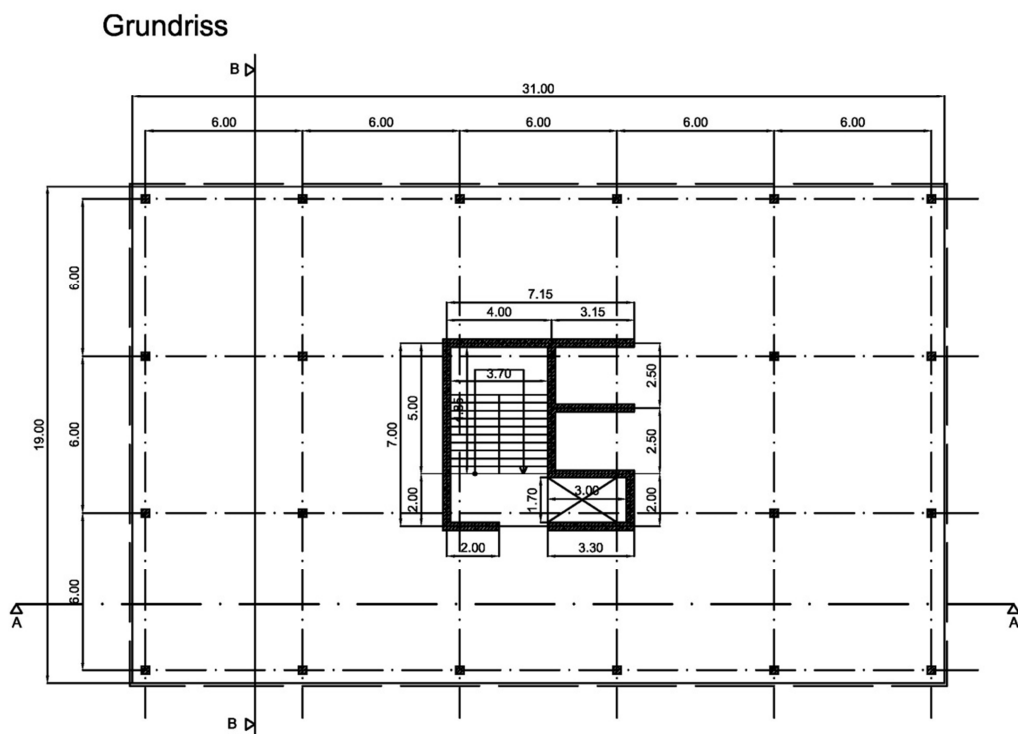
Grundriss Gebäudemodell 02
